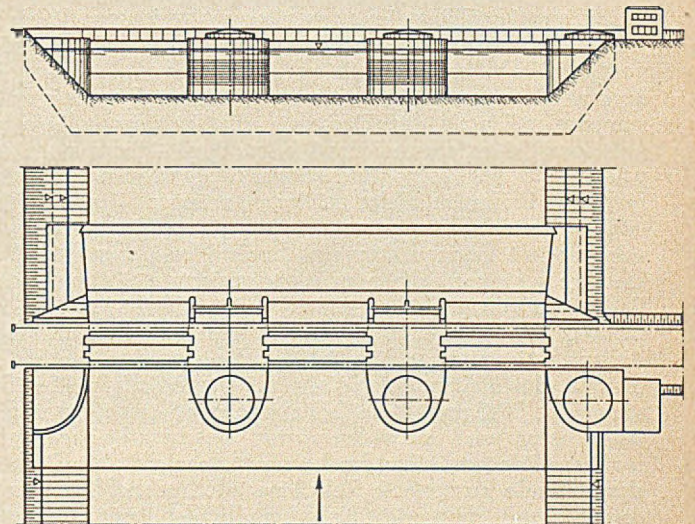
Oberwasserseitige Ansicht und Grundriß einer Staustufe mit Pfeilerkraftwerk.
